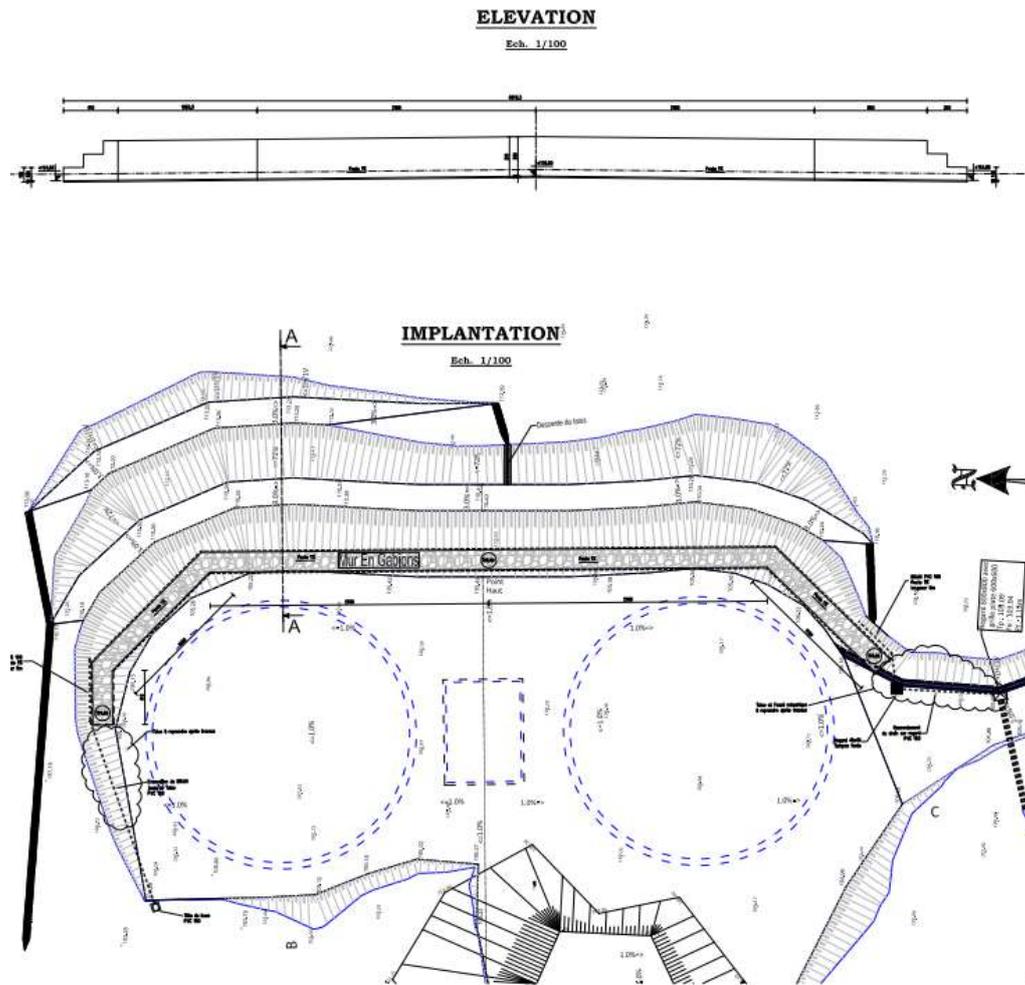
vue en plan et élévation de l'ouvrage en gabions
